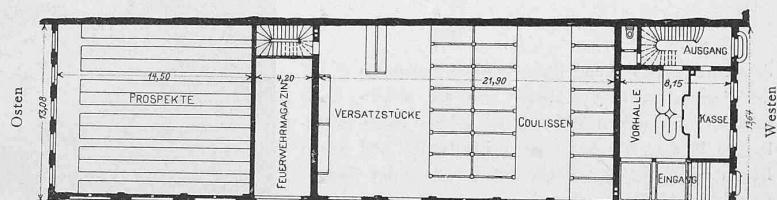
Grundriss des Theaterdekoration-Gebäudes. — Massstab 1 : 500.
